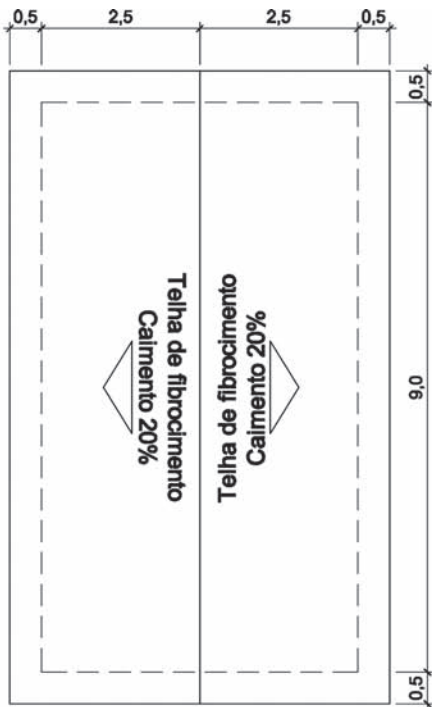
Croqui da planta de cobertura da habitação padrão de interesse social
